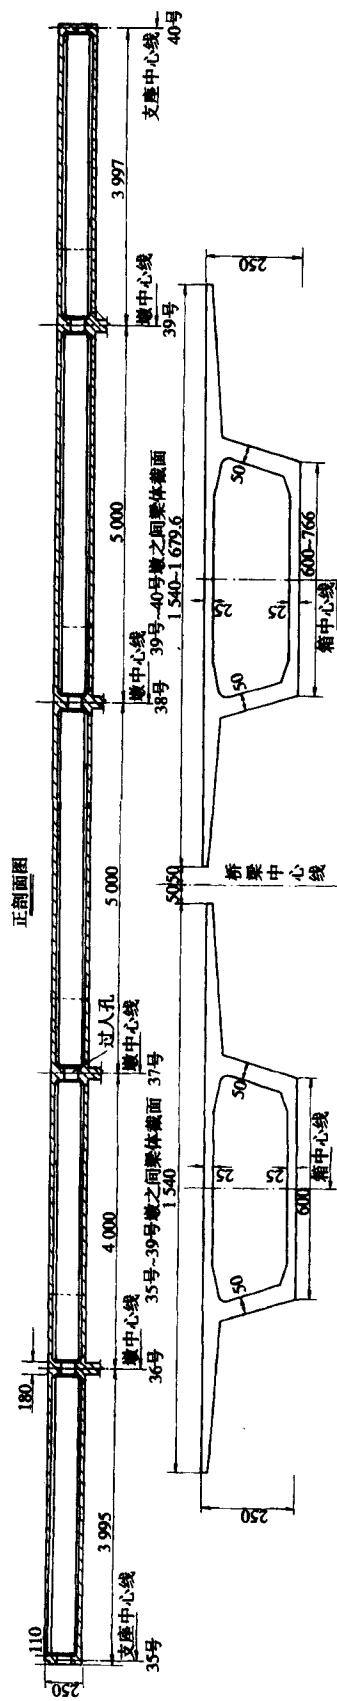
第一联梁体构造图(尺寸单位:cm)
